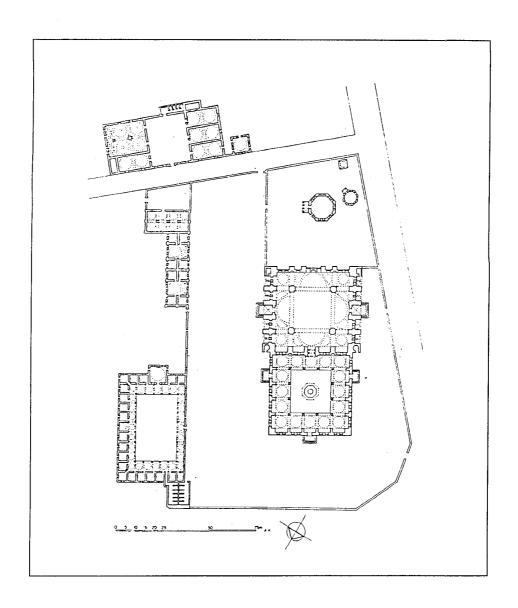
مسقط أفقي لمسجد الفاتح الأصلي ضمن مجمعه بإستانبول (عن: ايفردى).
